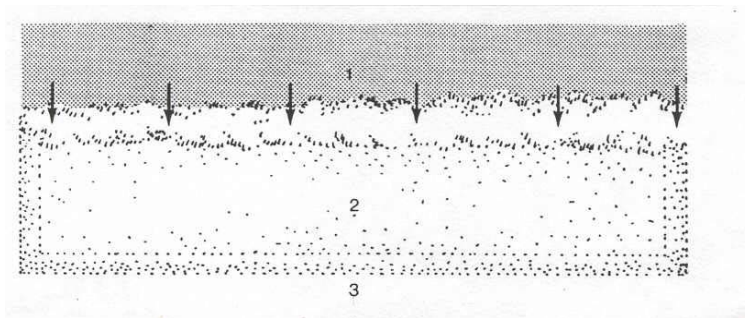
Estanque de infiltración en estacionamiento. 1.- Área impermeable, 2.- Estanque, 3.- Calle.
